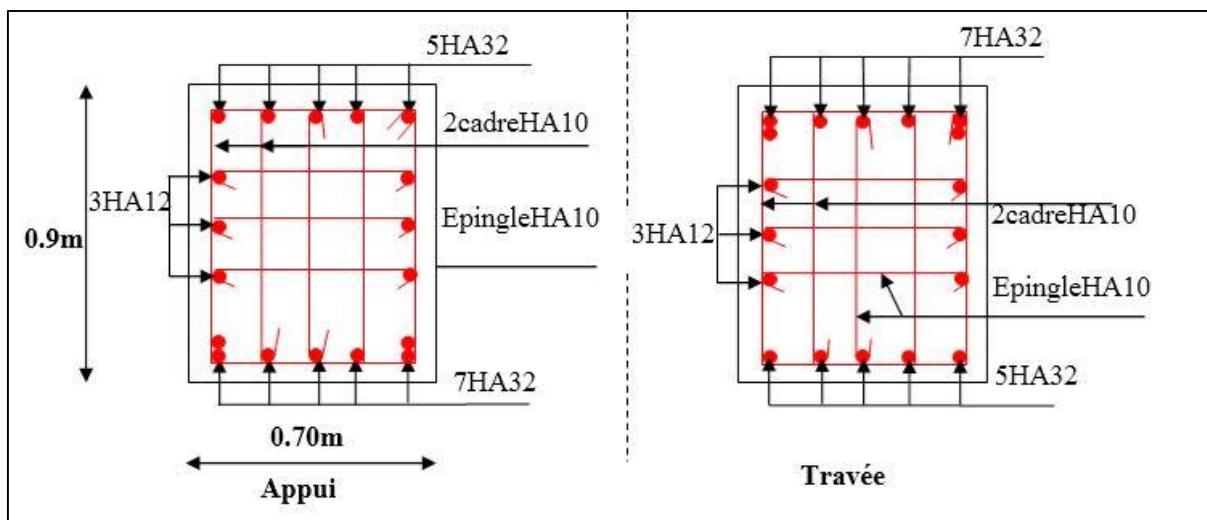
Schéma de ferrailage des nervures dans le sens x-x.
